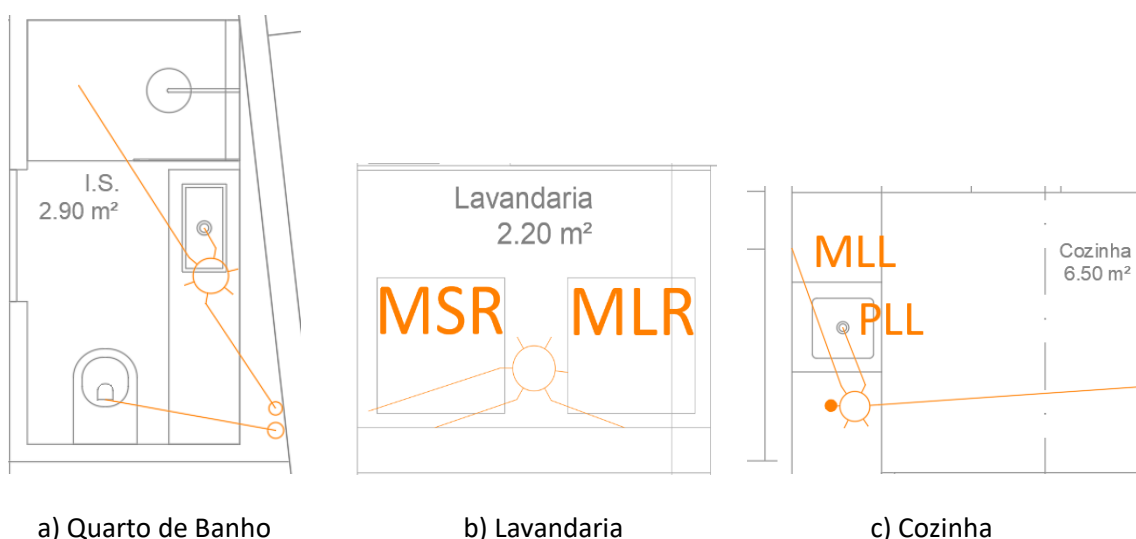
Traçado de ramais de descarga e de ligação às caixas de pavimento e tubos de queda.
